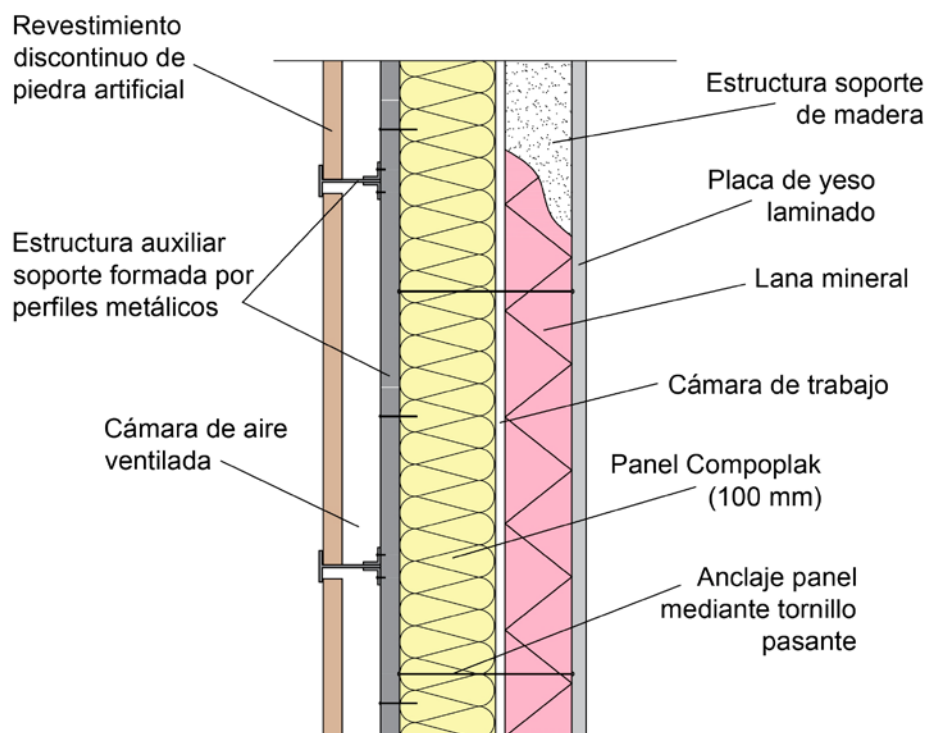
Detalle constructivo de fachada ventilada con Compoplak
